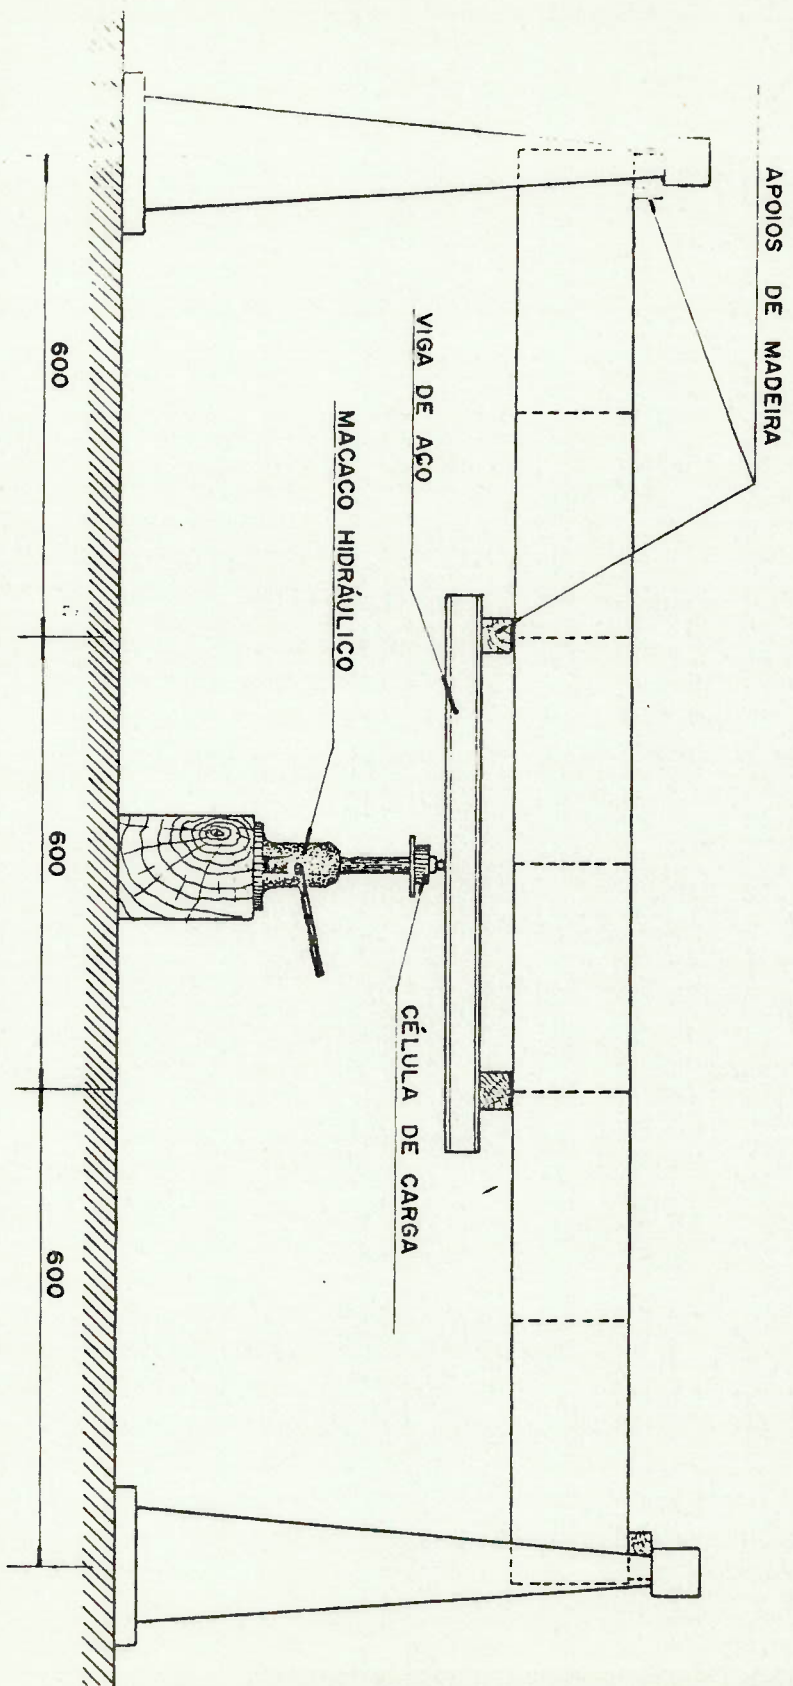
ESQUEMA PARA ENSAIO EM FLEXÃO
